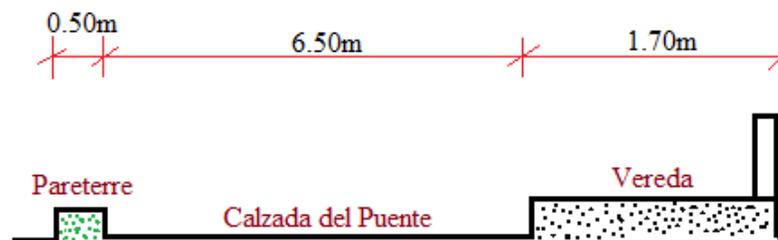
Detalle de la sección propuesta (Dirección Quito – Valle)
